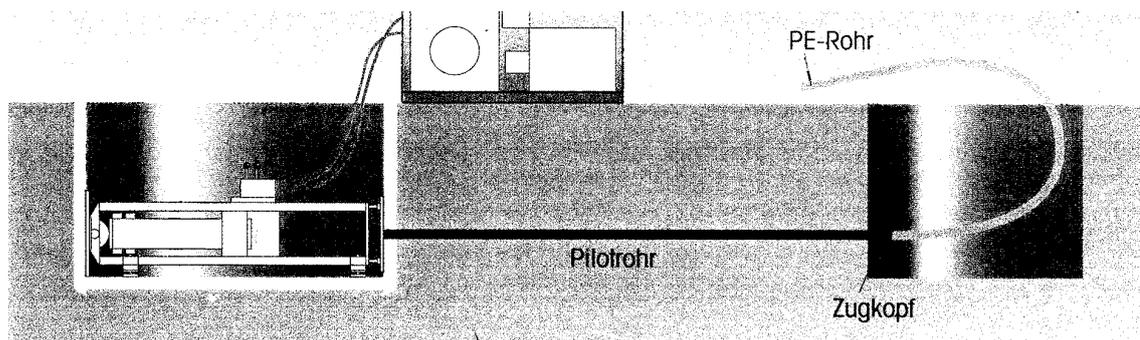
Rückziehen des Pilotrohres und des PE-Rohres [1]
